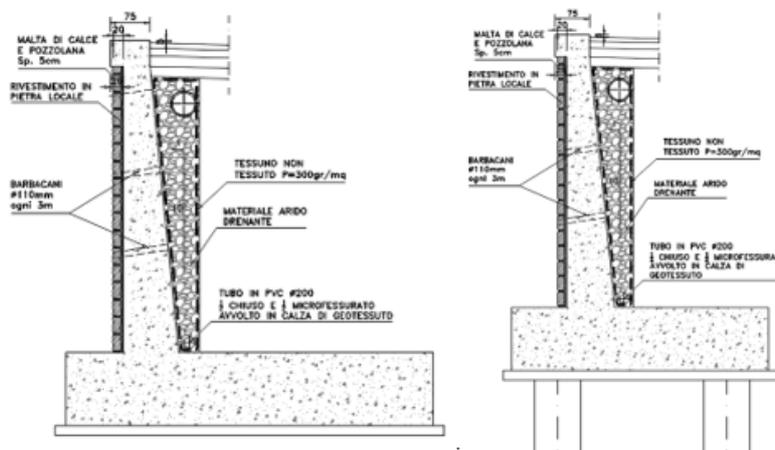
Sezione tipo muro di sostegno su fondazione diretta (a sx) e sezione tipo muro di sostegno su pali (a dx)
